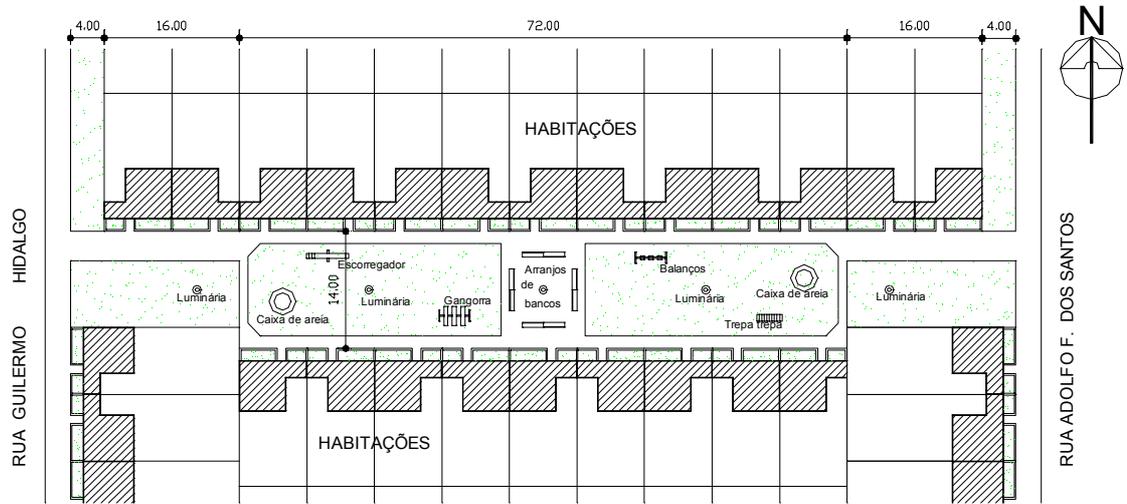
Planta Original do Espaço Aberto Comum 2 do CHST
